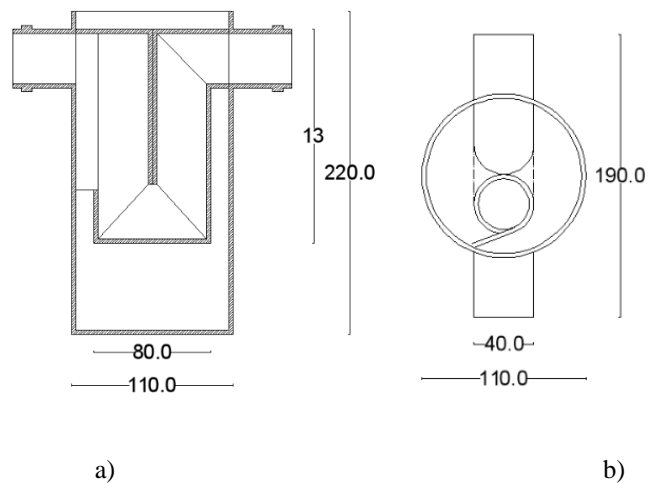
Representação concepção – Protótipo 5, (a) Corte transversal, (b) Planta
